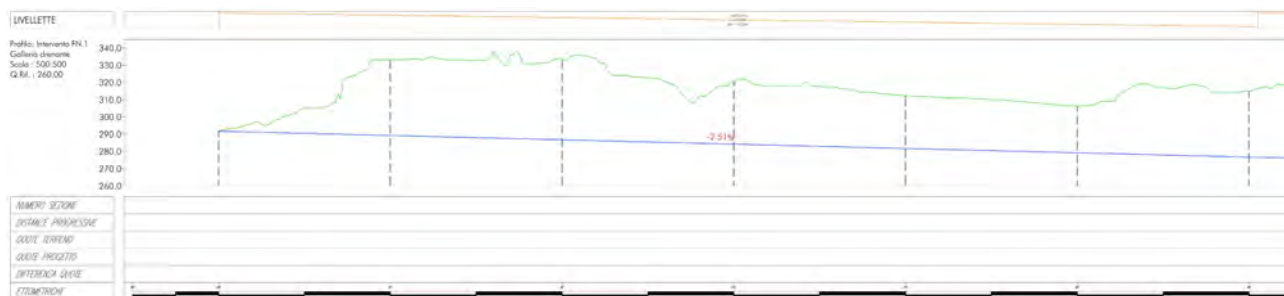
Parte 1 del profilo altimetrico d'asse dell'orizzontamento inferiore della galleria drenante.
